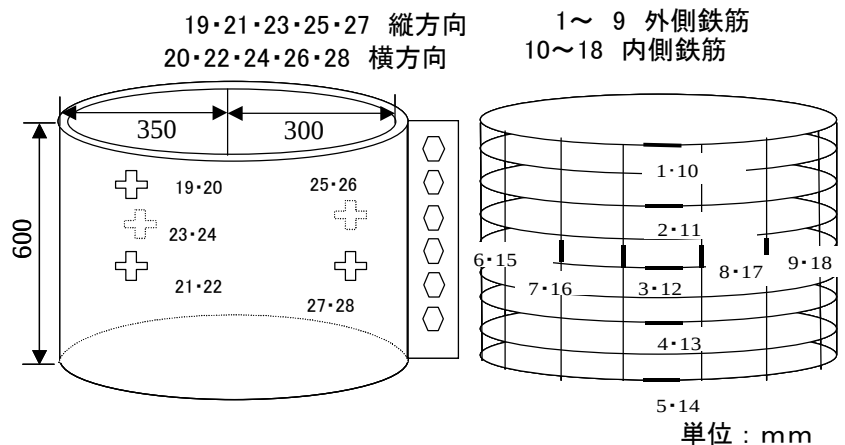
型枠の形状および鉄筋のゲージ貼付け位置図
